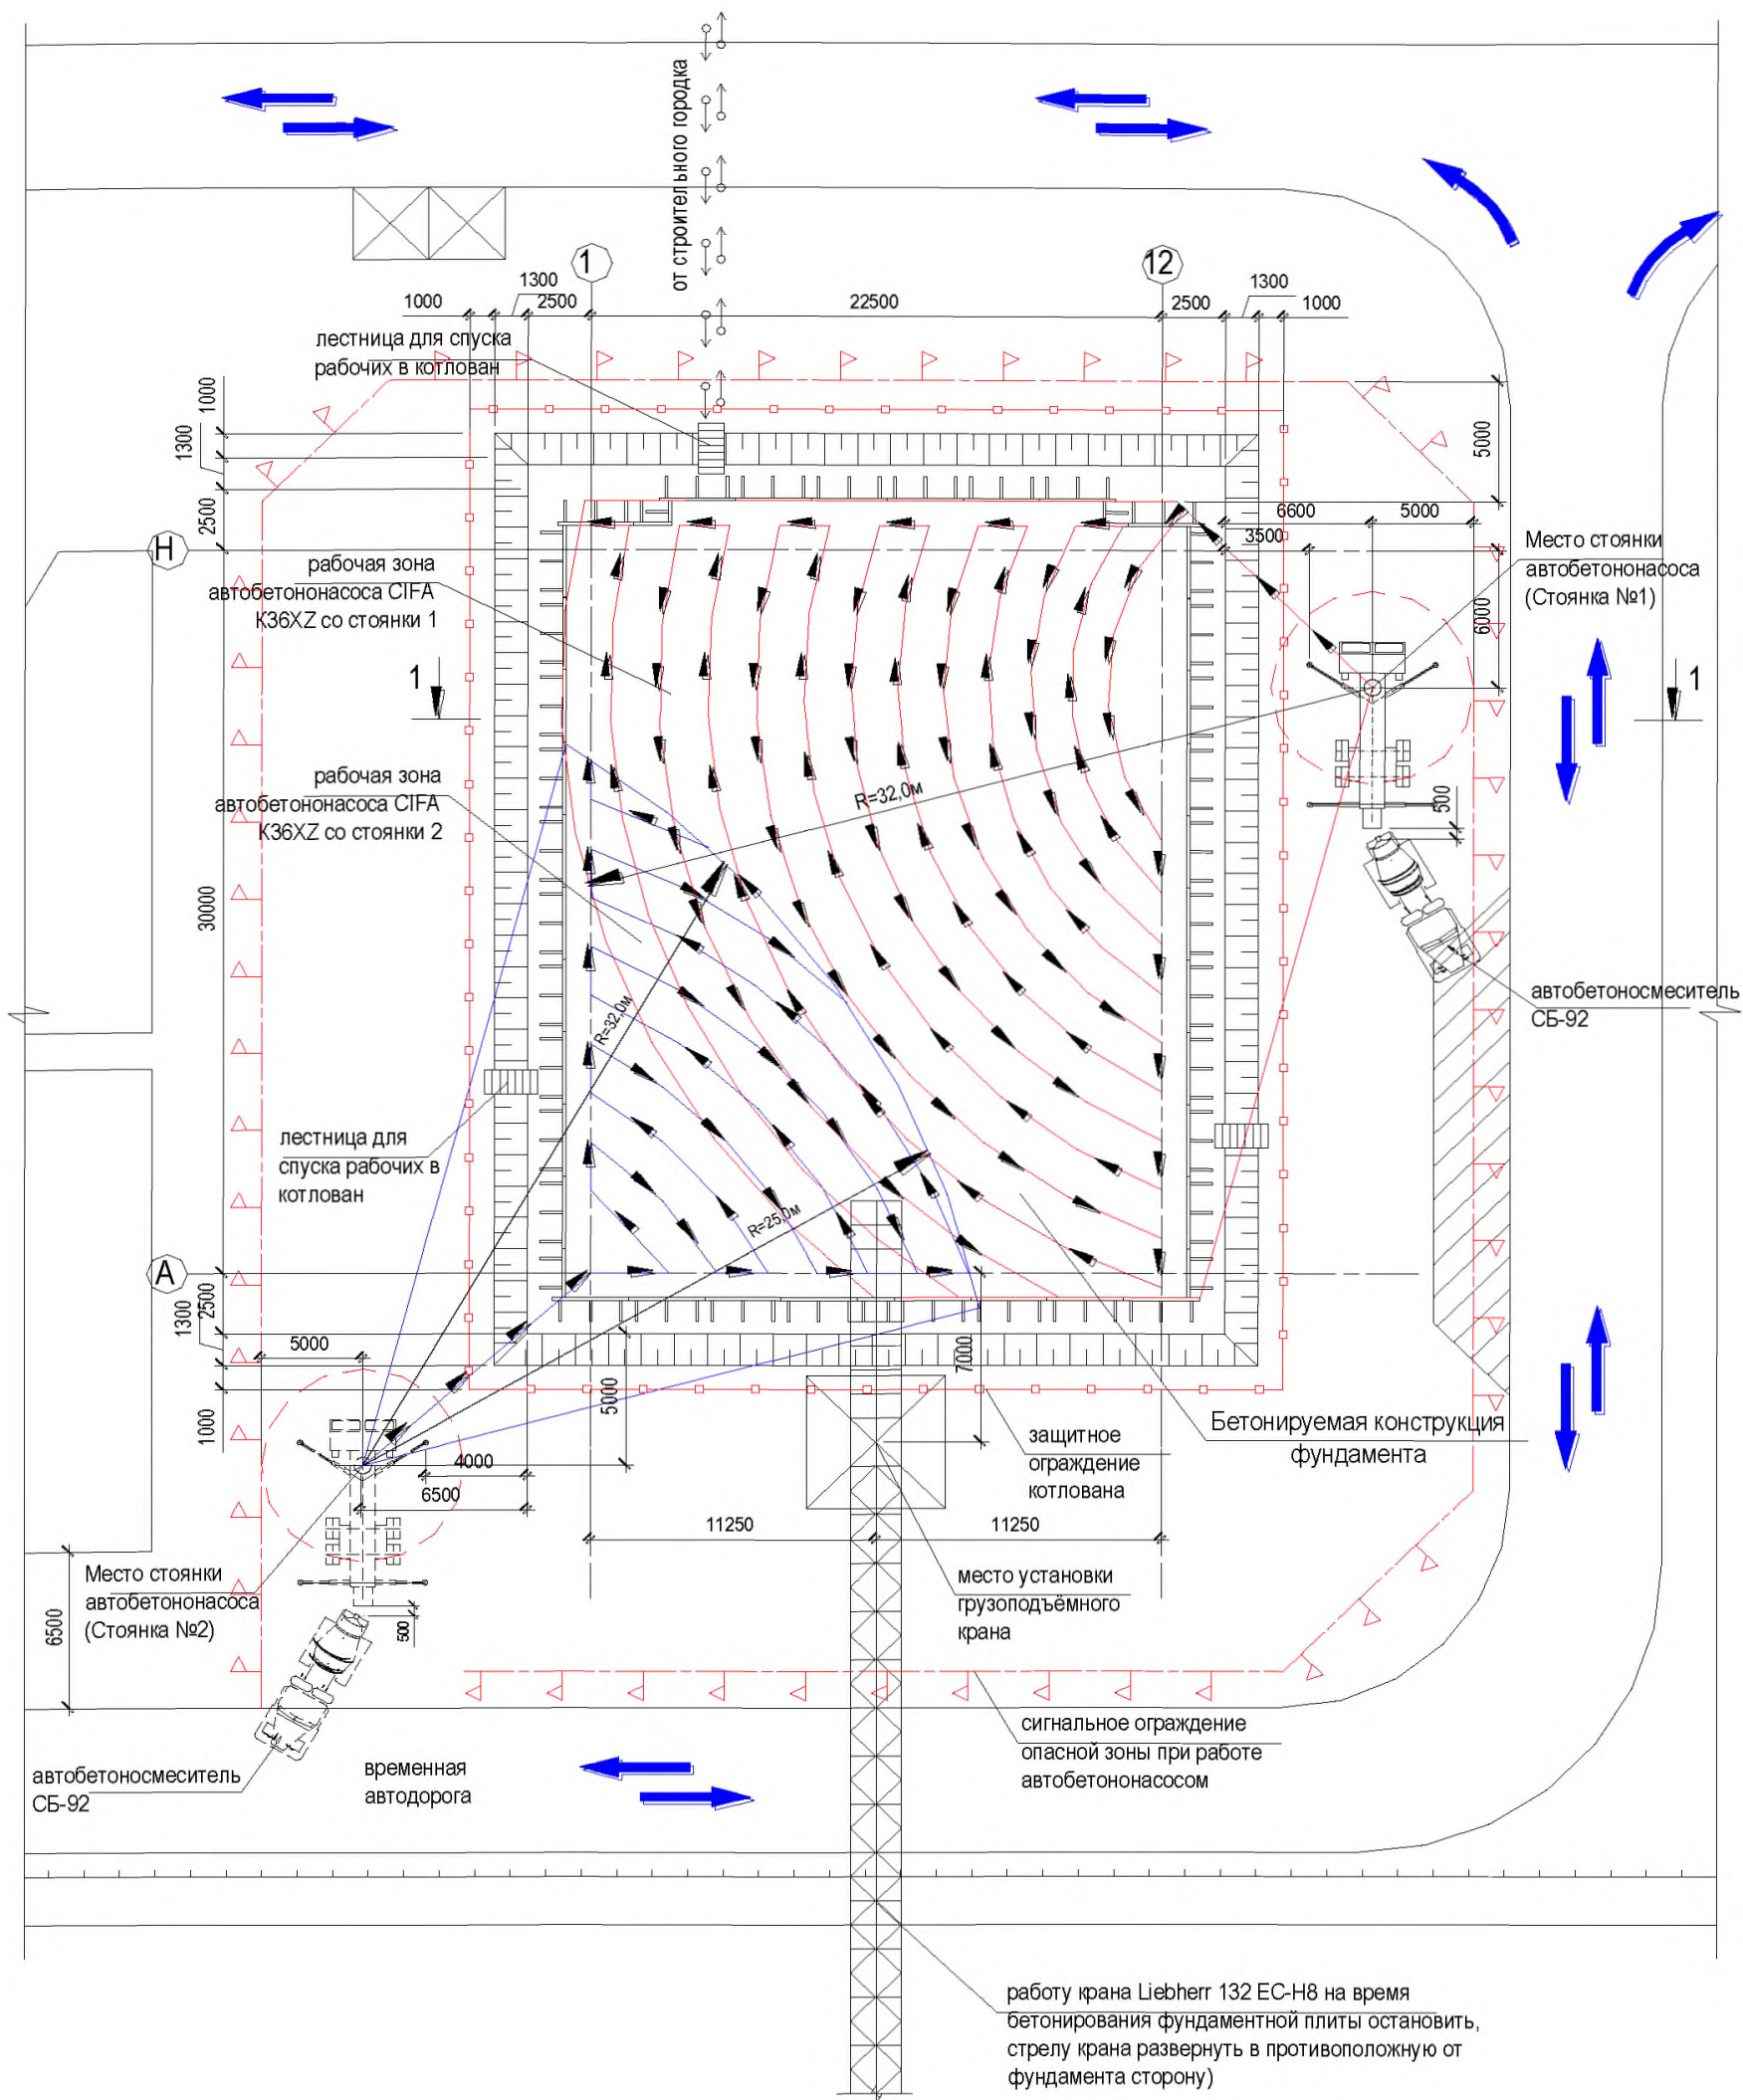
Схема производства работ по бетонированию фундаментной плиты
